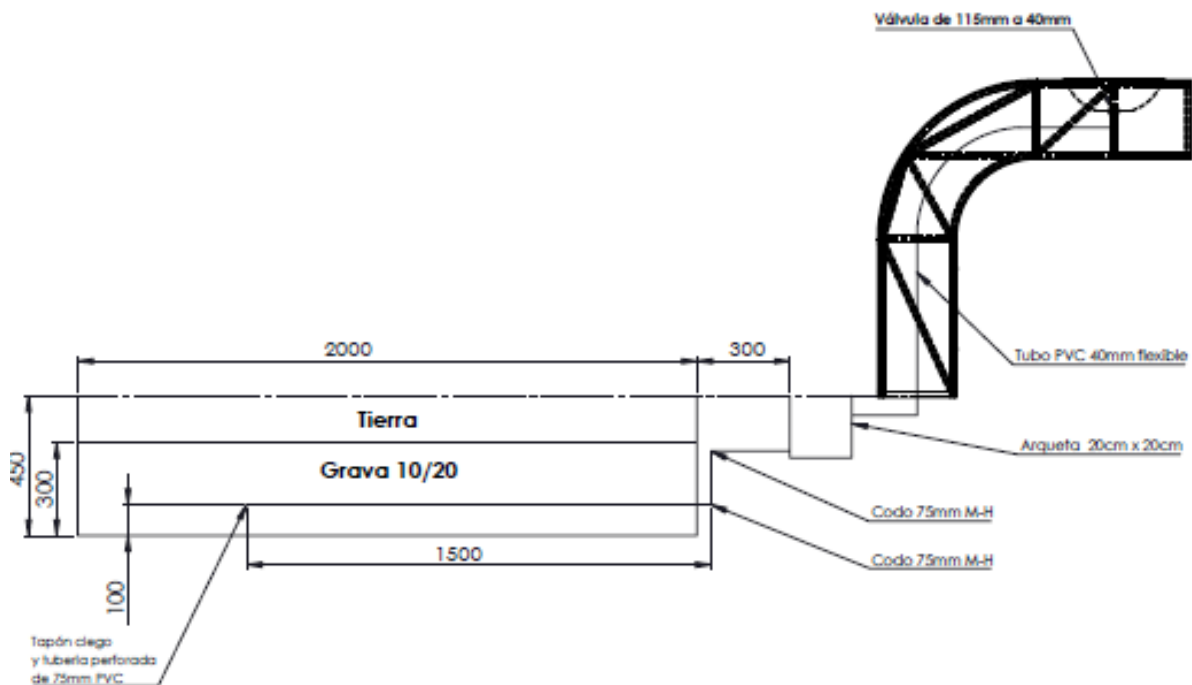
Diseño de saneamiento de la Fuente de exterior. Unidades: mm
